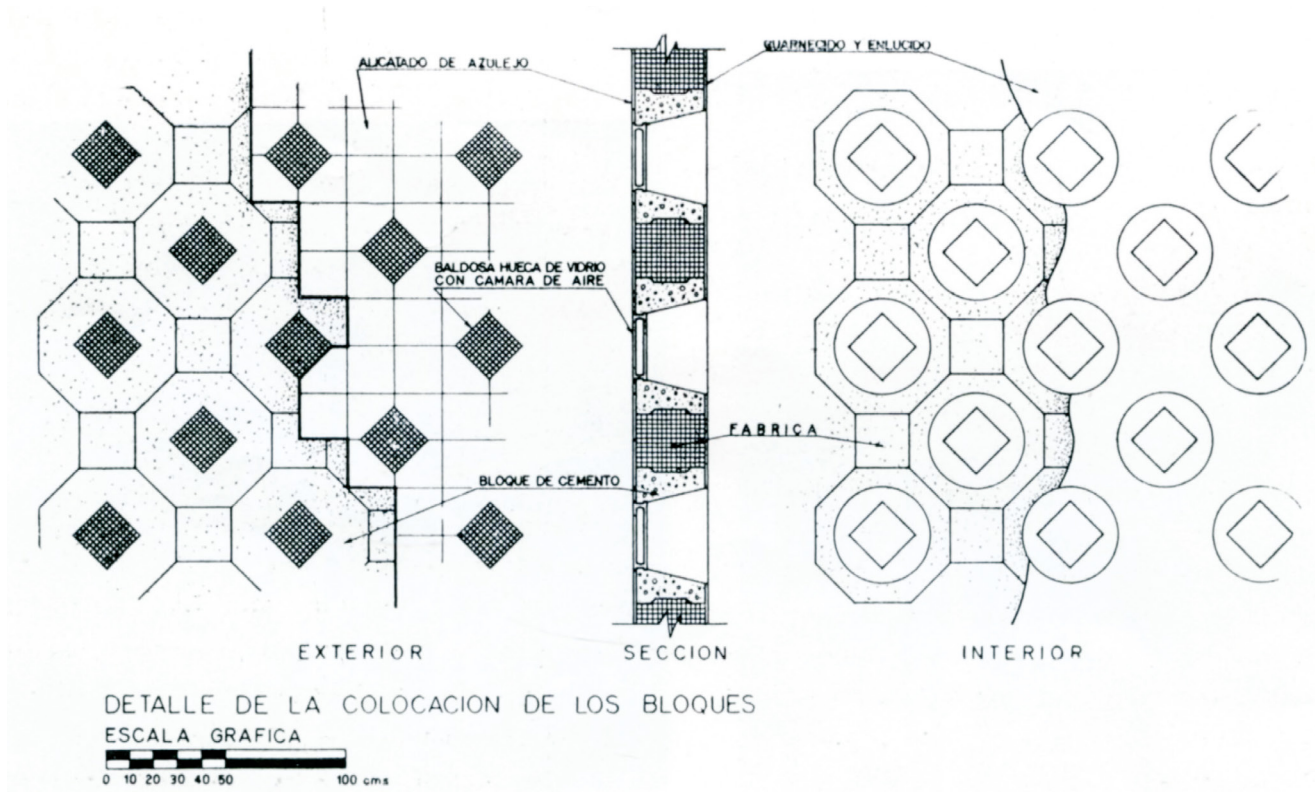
Detalle de la celosía publicado en la Revista Nacional de Arquitectura, 201 (1958), p. 6.
